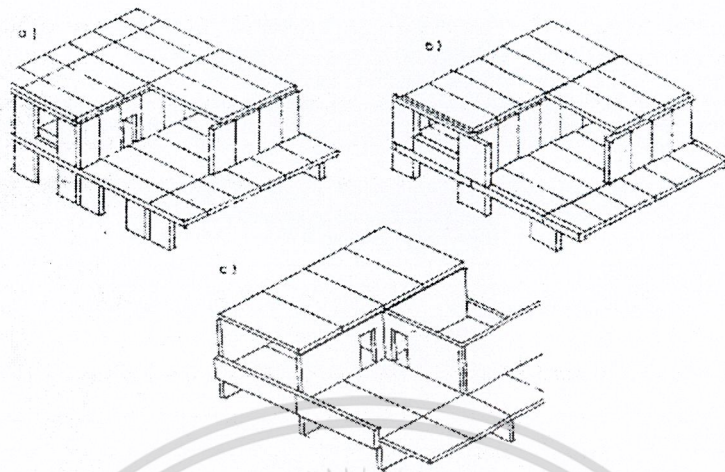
ระบบ โครงสร้างแบบ Long Wall (สมภพ, 2516)
